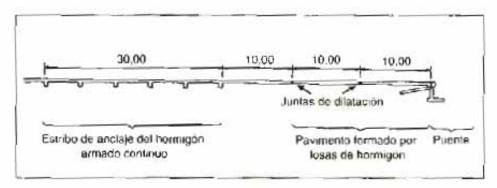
Disposición constructiva belga empleada con pavimento de hormigón armado continuo. Cotas en metros.
